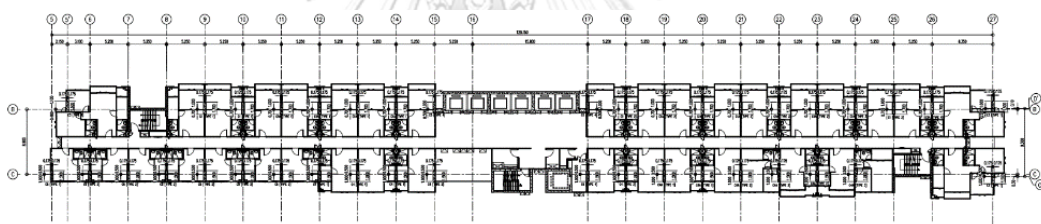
แผนผังของ Typical Building (อาคาร A) ดัดแปลงจาก Jeong, et. al, 2021
